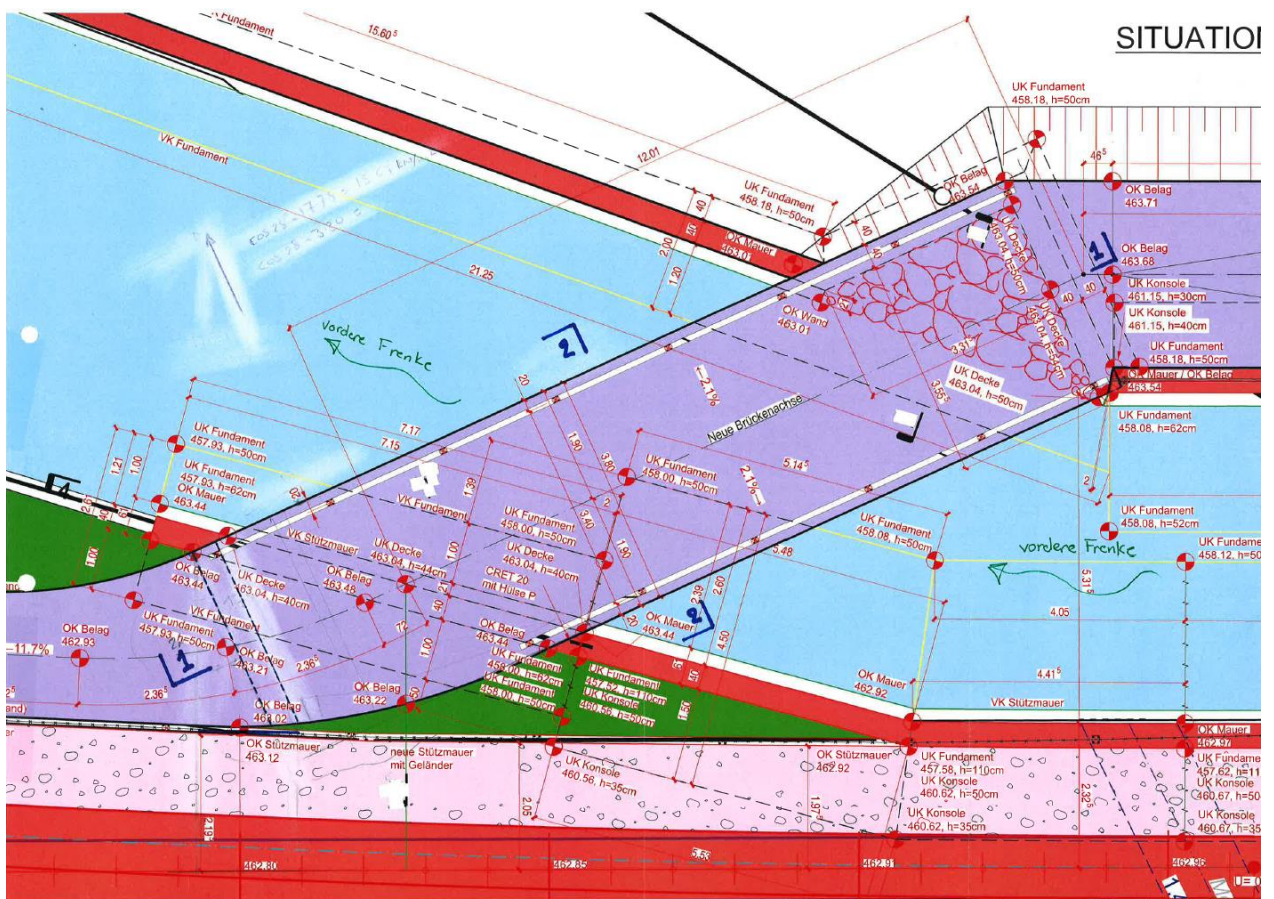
Grundriss der Brückenplatte Steg Hirschlang
